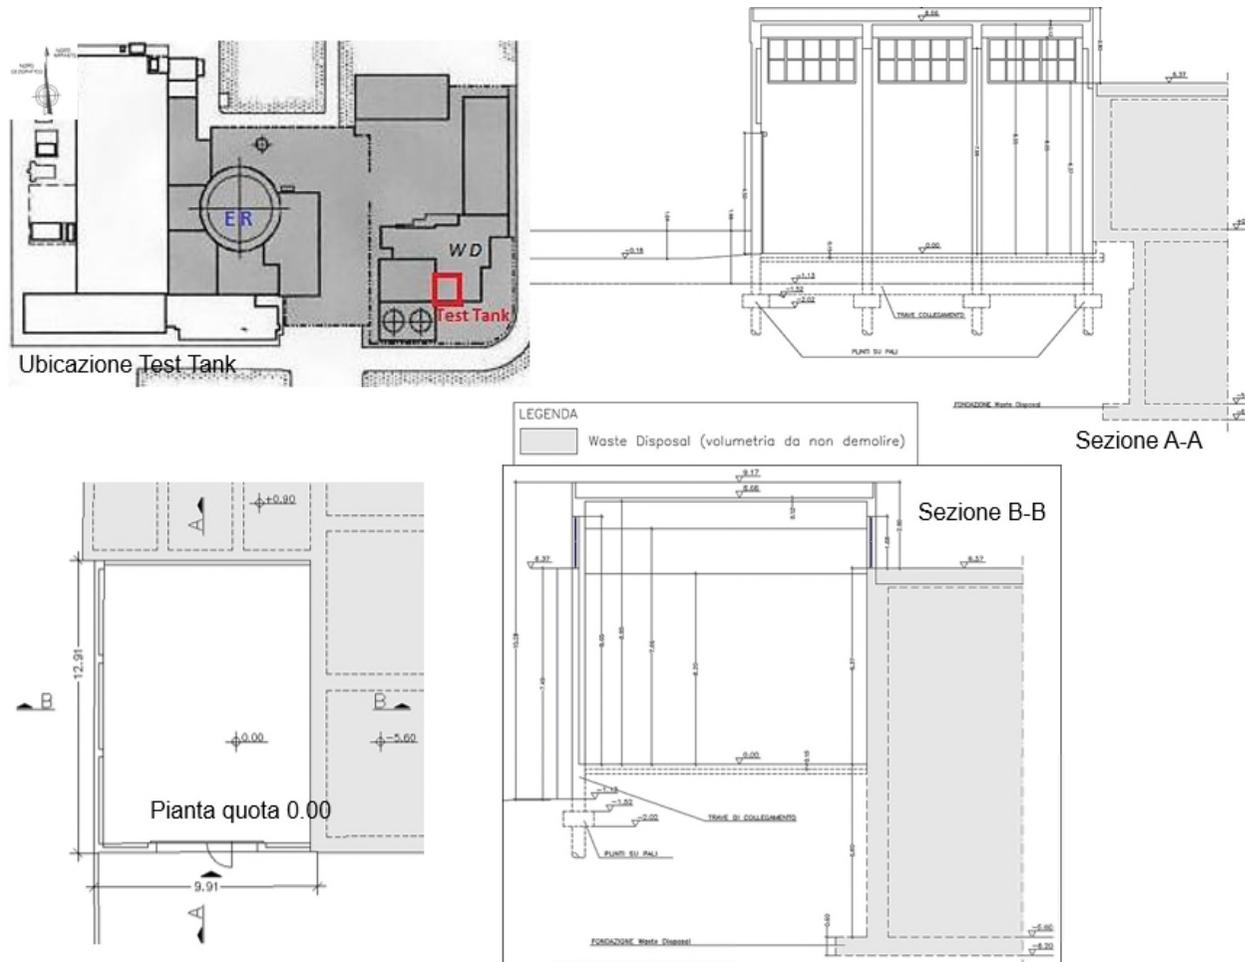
Ubicazione, pianta, sezione longitudinale e sezione trasversale edificio Test Tank *ante-operam
